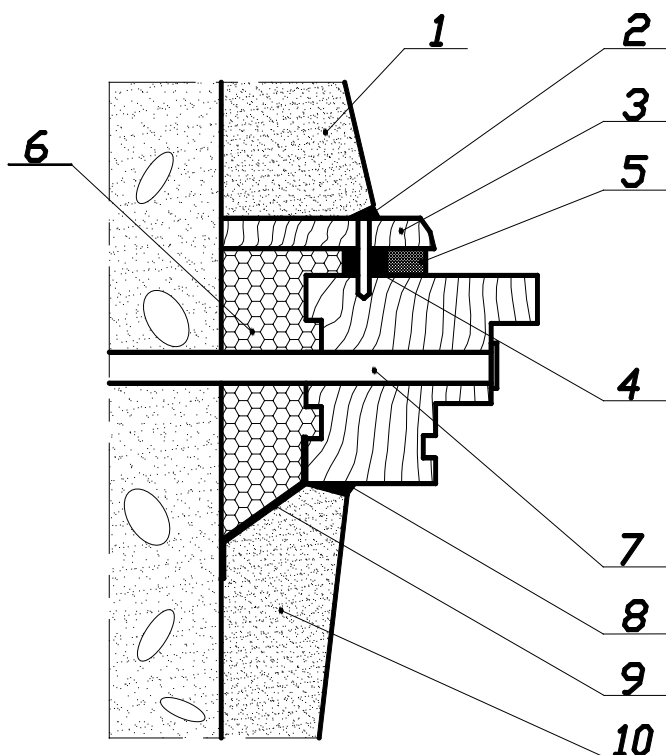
Узел бокового примыкания оконного блока к проему без четверти в стене из легковесных блоков с отделкой, наружных и внутренних откосов штукатурным раствором
